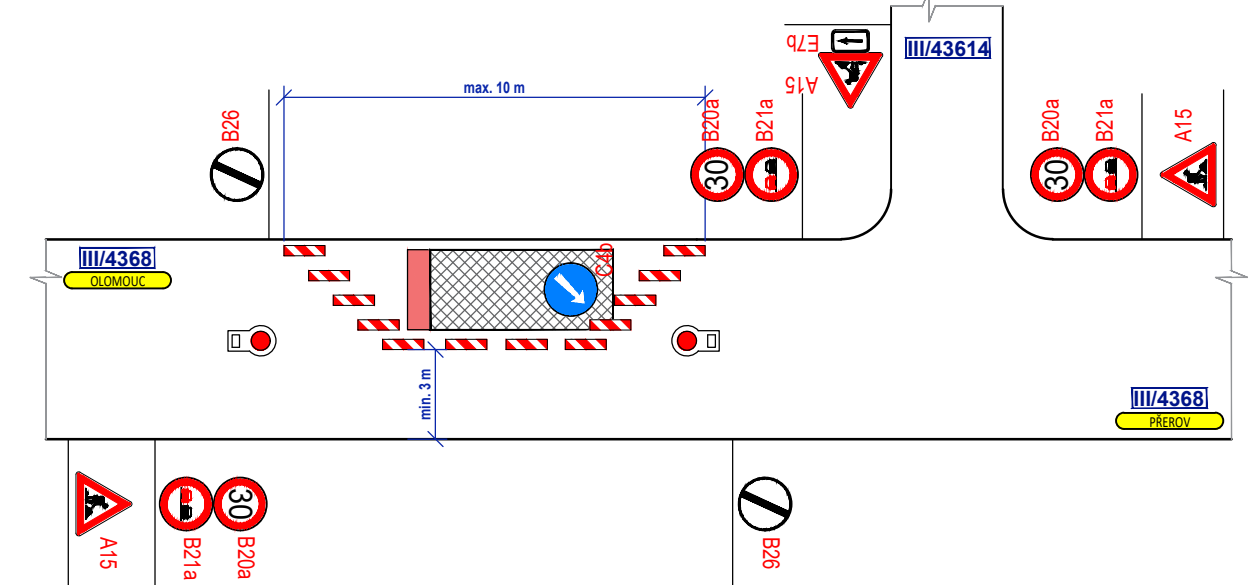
### DETAIL PRACOVNÍHO MÍSTA 2 - INTRAVILÁN
